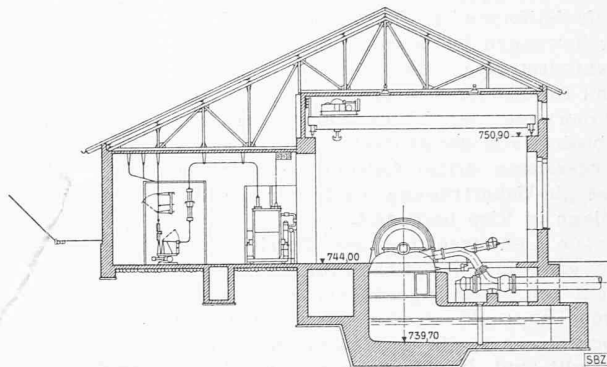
Querschnitt durch das Maschinenhaus, 1:400
